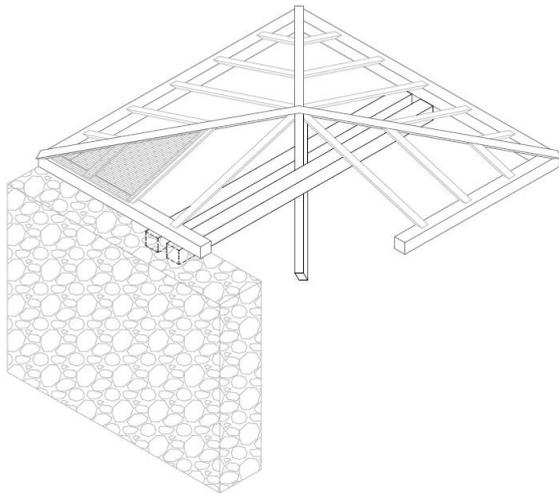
Detalle cubierta camarín. 2015. Fuente: J.C.A.
